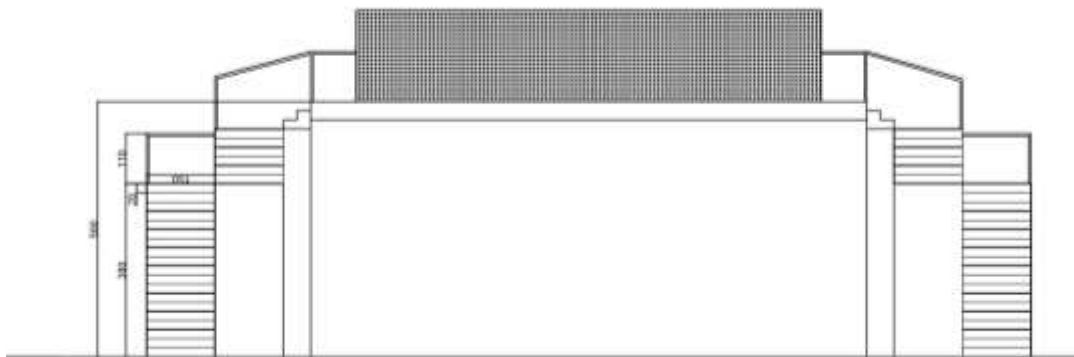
Elevation of the pedestrian bridge at Ahmad Yani Street
